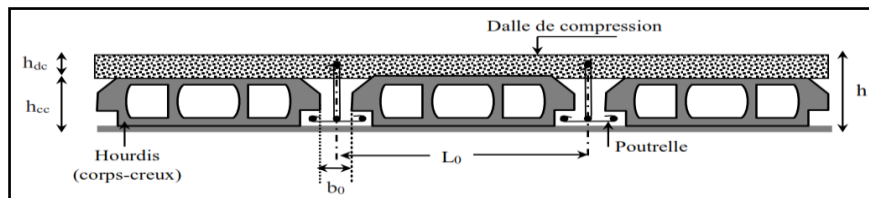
Coupe transversale d'un plancher à corps creux
